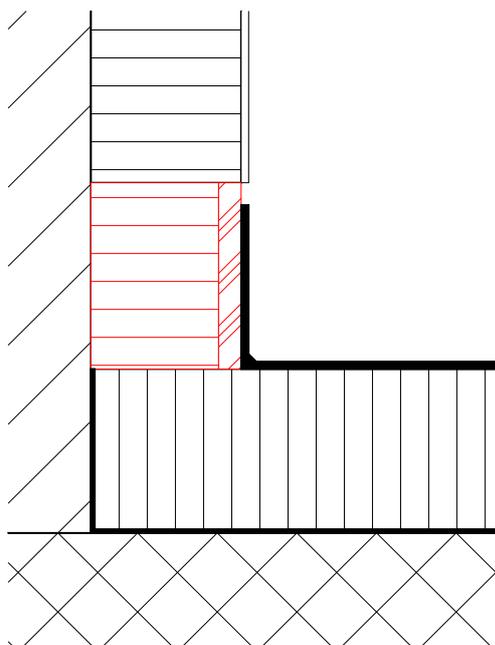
\*: Adapter les détails de construction, par exemple en installant une isolation thermique non combustible (l'étanchéité de la façade doit être garantie).
